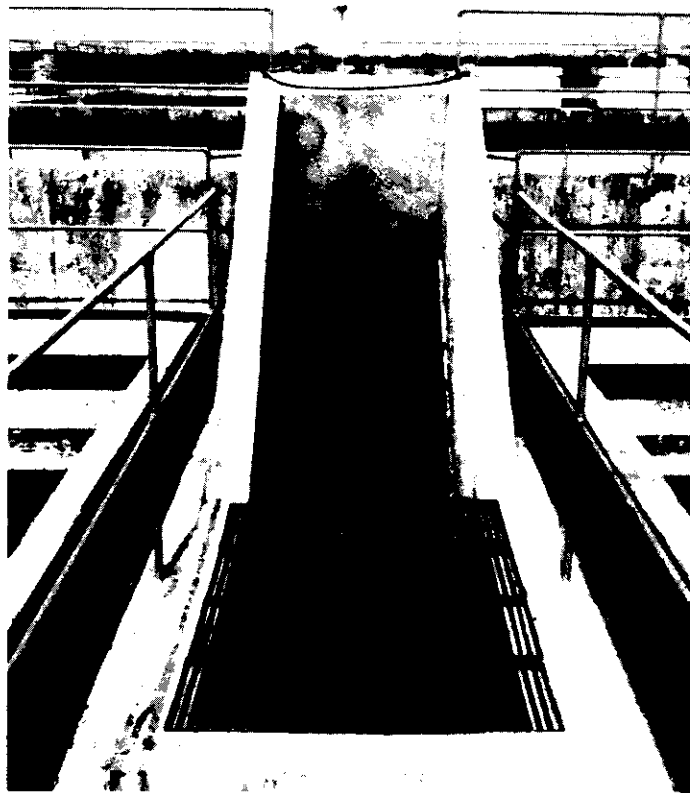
Elevatória para recirculação de lodo, entre dois decantadores
